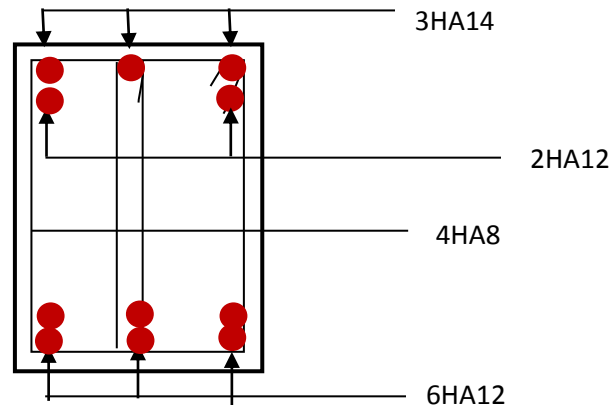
Ferrailage sur appuis d'une poutre secondaire.
